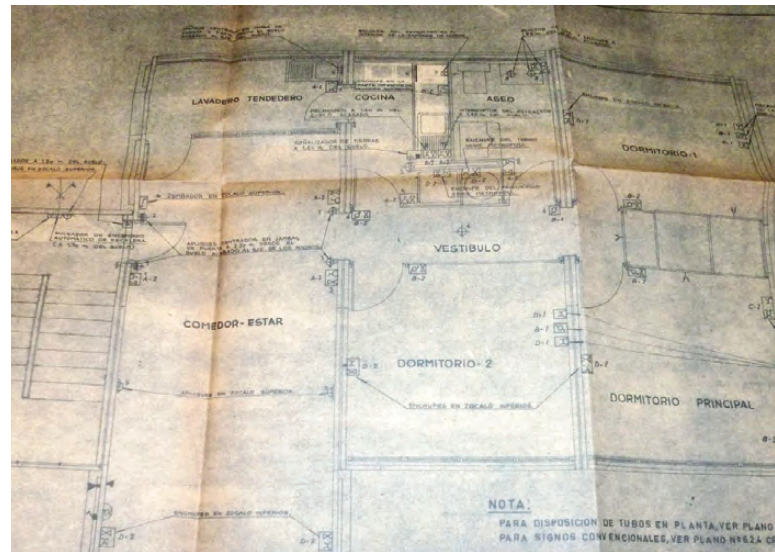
Planta tipo con 3 vigas habitables, Maite Palomares (2008), Proyecto / Figure 3. Ground type with 3 habitable beams, Maite Palomares (2008), Project.
